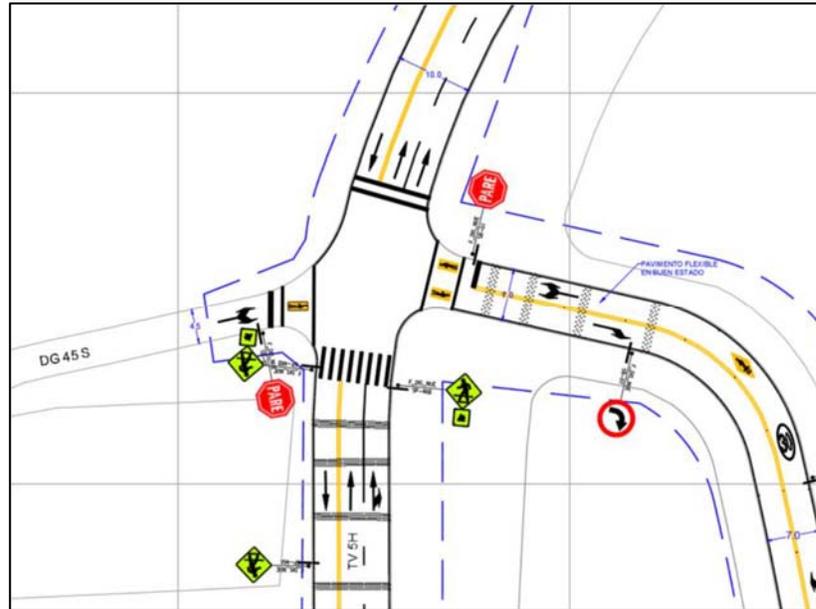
Transversal 5 con prolongación de la Calle 48B Sur
